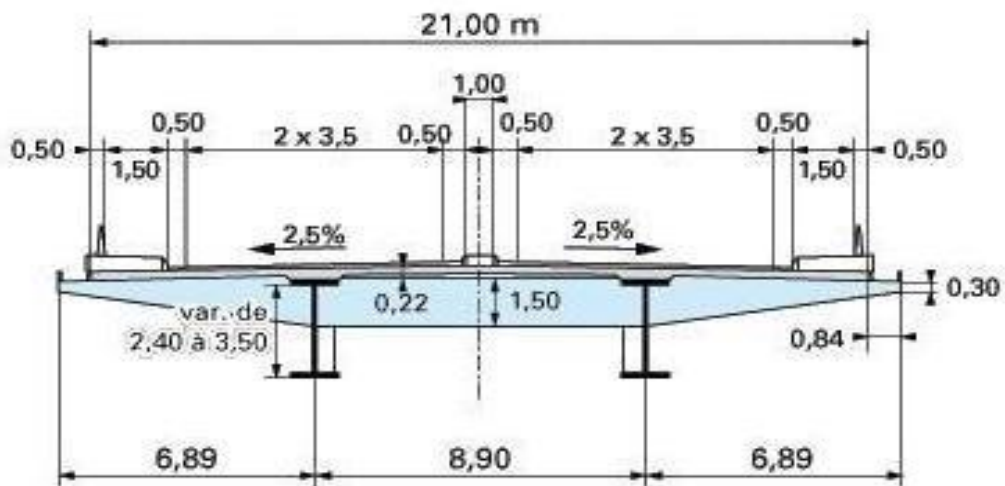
Bipoutre à pièces de pont avec consoles.
